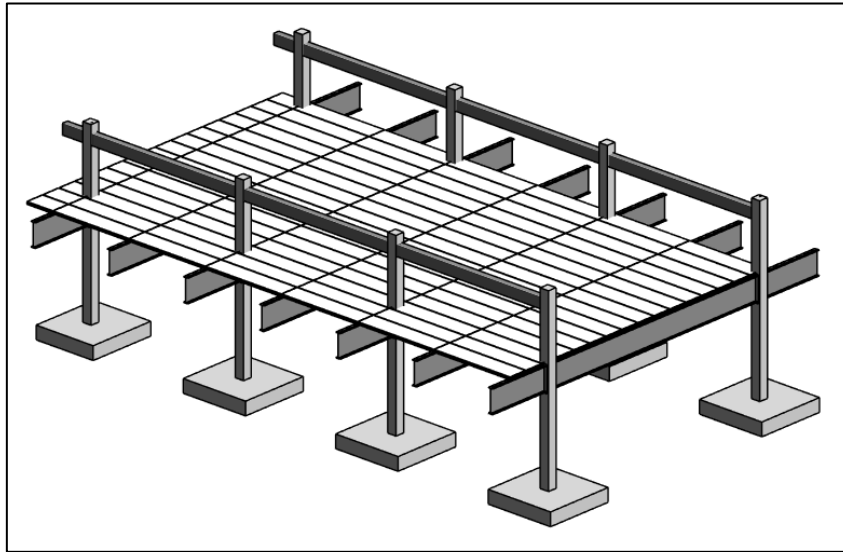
Colocación de vigas conformadas sobre primer piso. Fuente: Autor.
